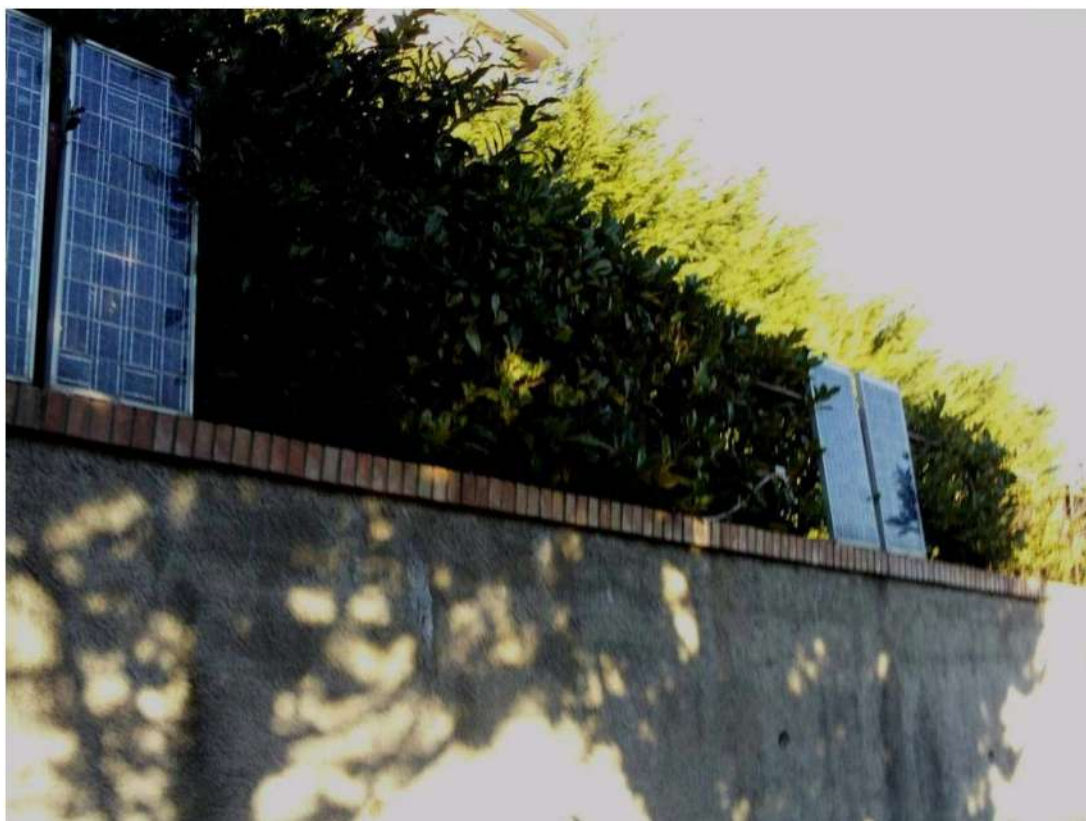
Foto esterna : impianto fotovoltaico per illuminazione esterna
